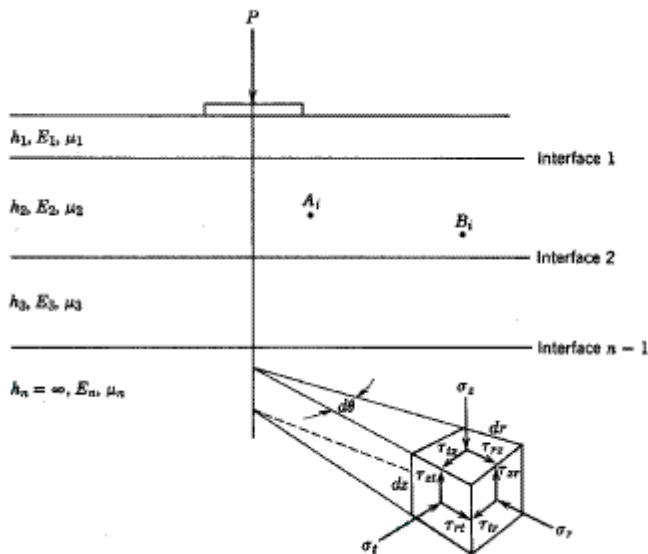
b.32 Sistema multicapa de un pavimento.
